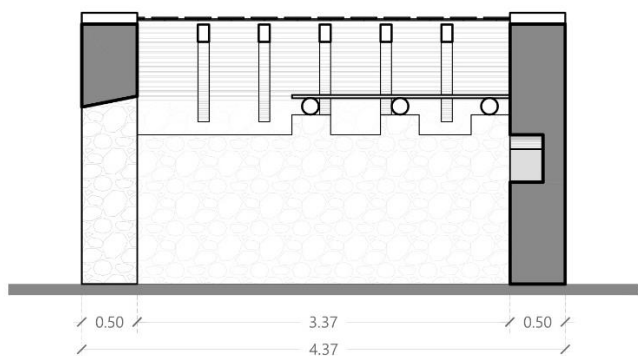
Corte longitudinal C-C'. Casa de Piedra, ejemplo 1. Fuente: Elaboración propia.
